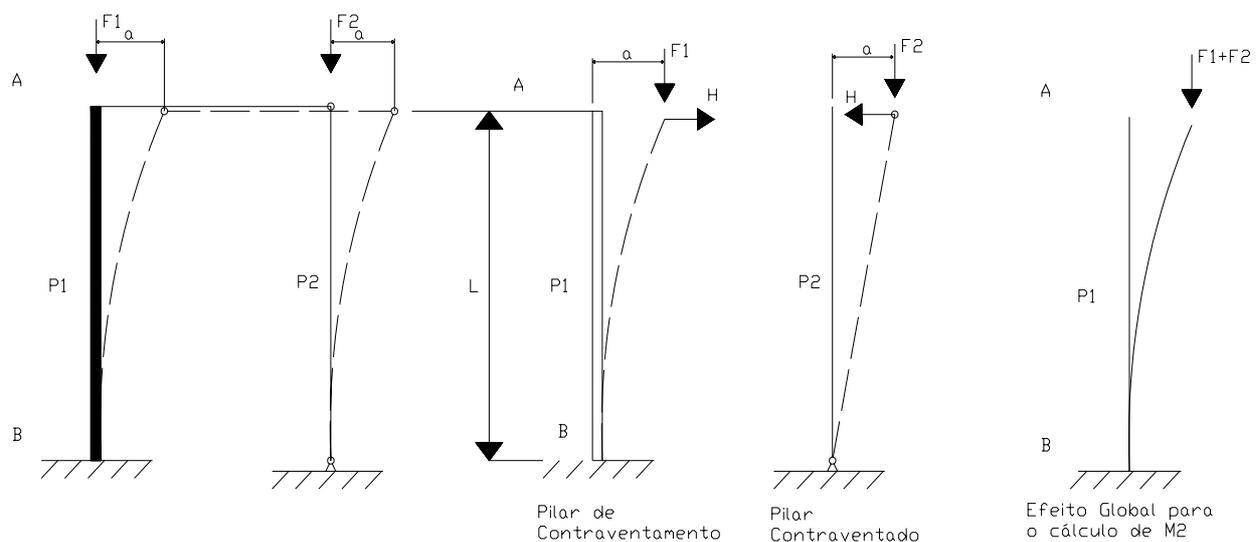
Funcionamento básico das estruturas de contraventamento [13]
